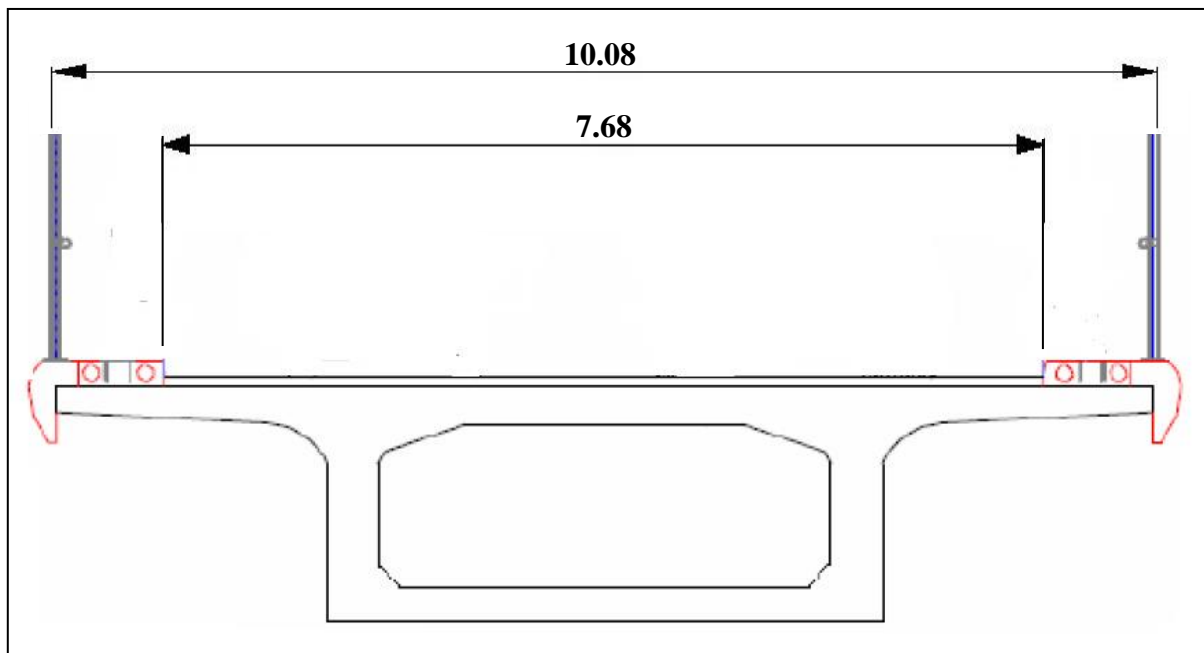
Coupe transversale au niveau des voussoirs.
